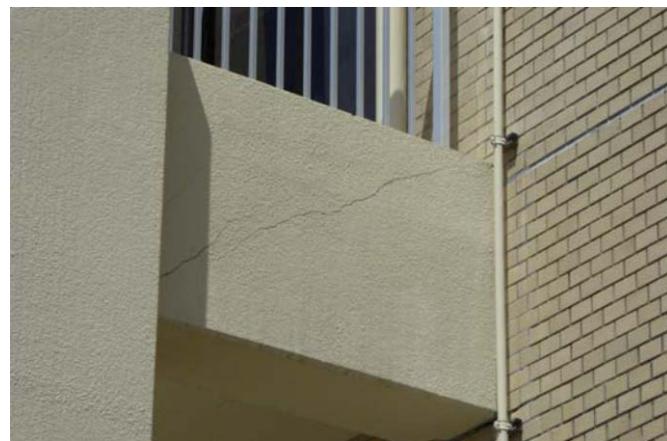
補強フレーム短スパン梁にせん断ひび割れ
